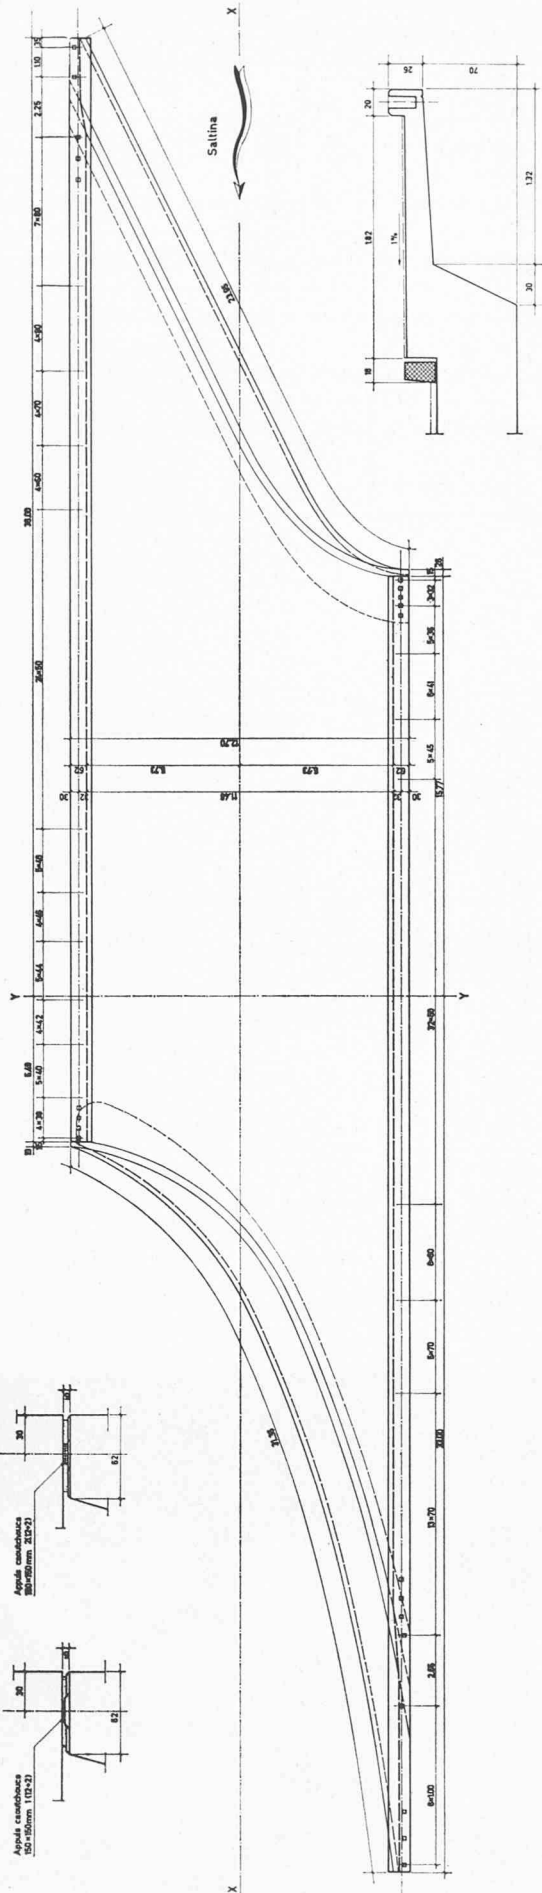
Plan de la dalle avec ses principales dimensions.
